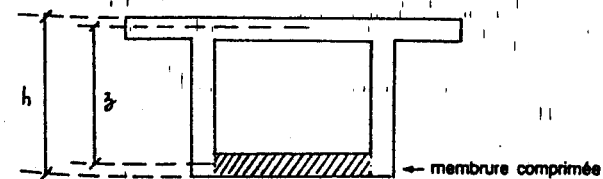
Prise en compte de l'effet RESAL sur les poutres caissons
